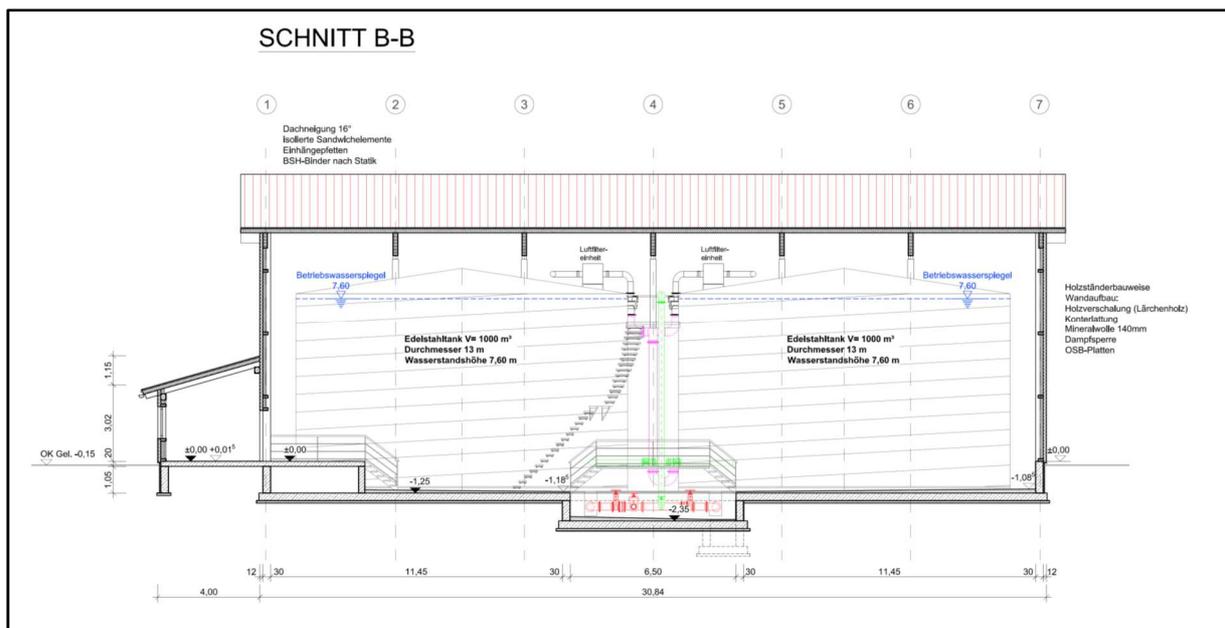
Schnitt B-B durch den Hochbehälter im Denklinger Rotwald; Quelle Plandarstellung Dr. Blasy – Dr. Øverlånd GmbH + Co. KG, 82279 Eching, Moosstraße 3
